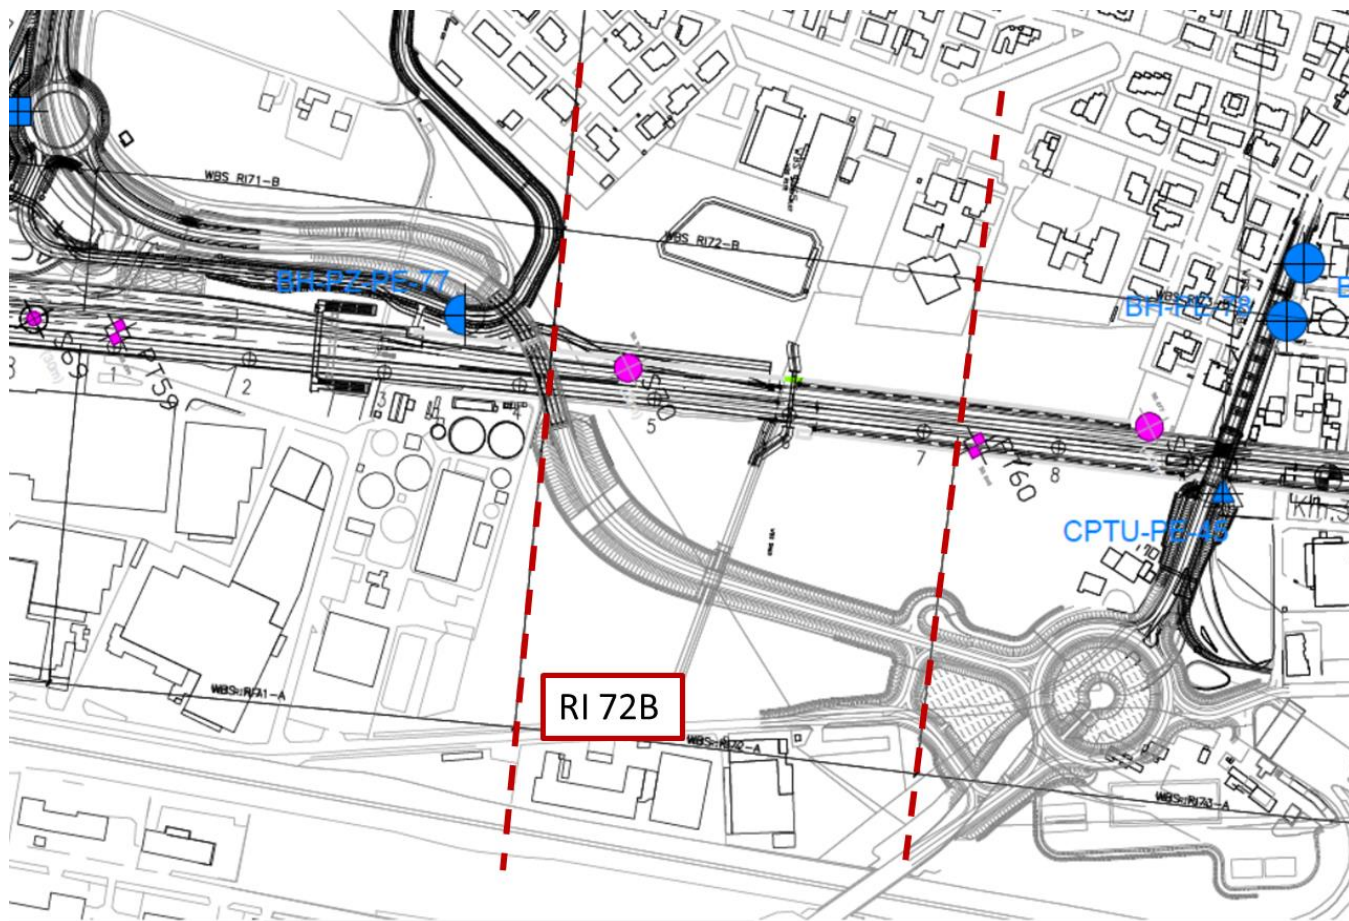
Planimetria Rilevato RI72B, estratto dalla Planimetria Generale (Doc. Rif. [3])
